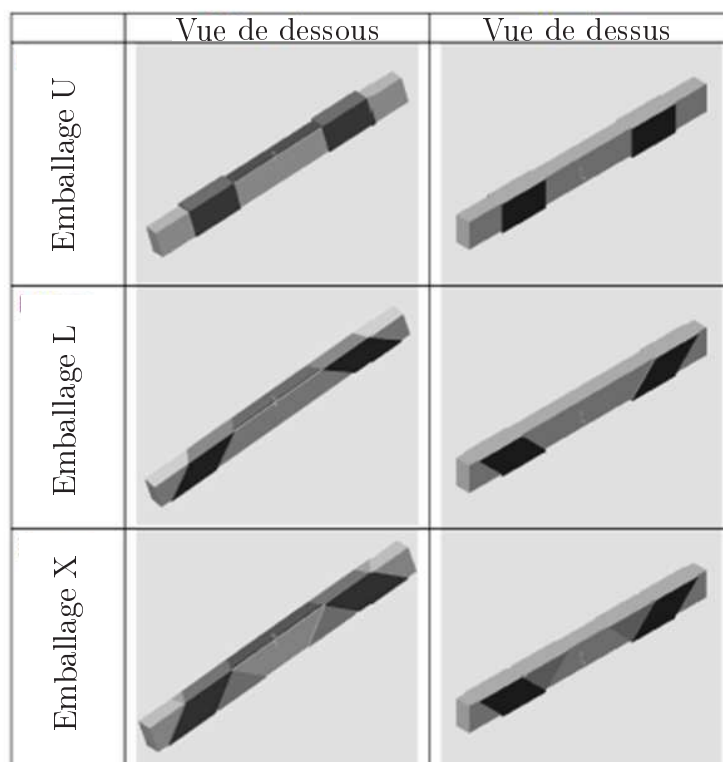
Emballage de poutres en forme U, L et X
